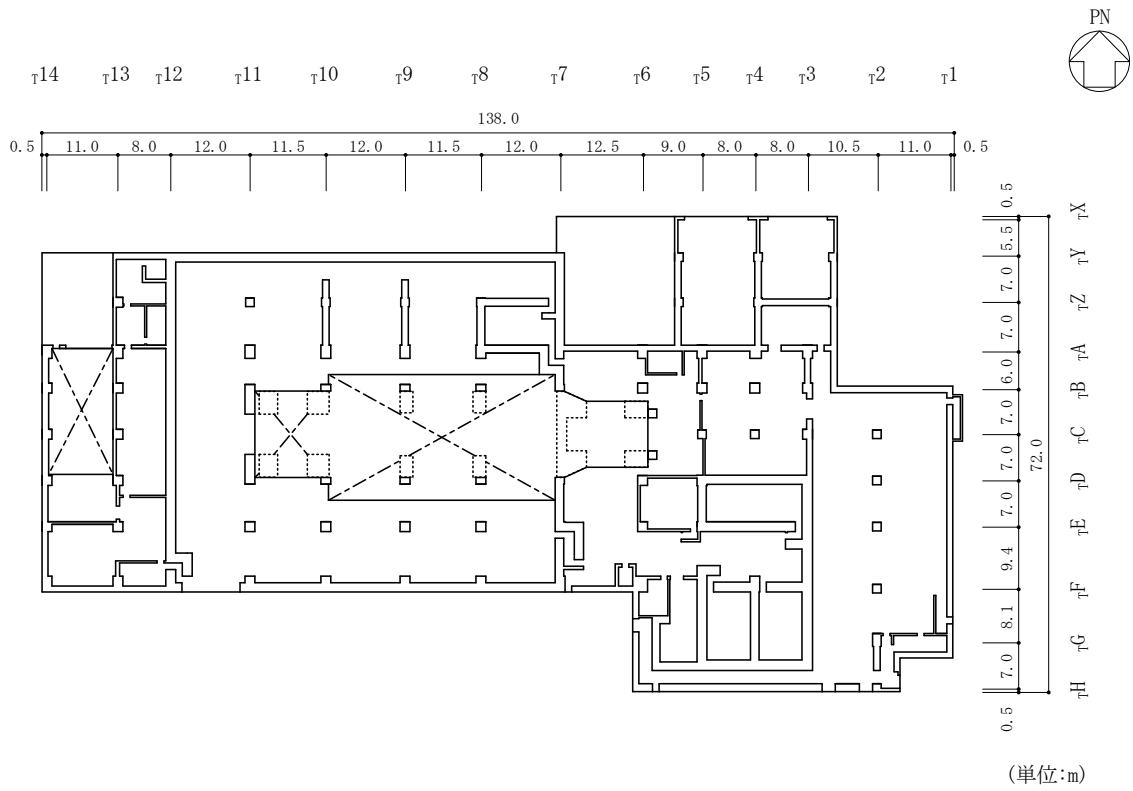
(3) タービン建物の概略平面図 (EL 12.5m)
